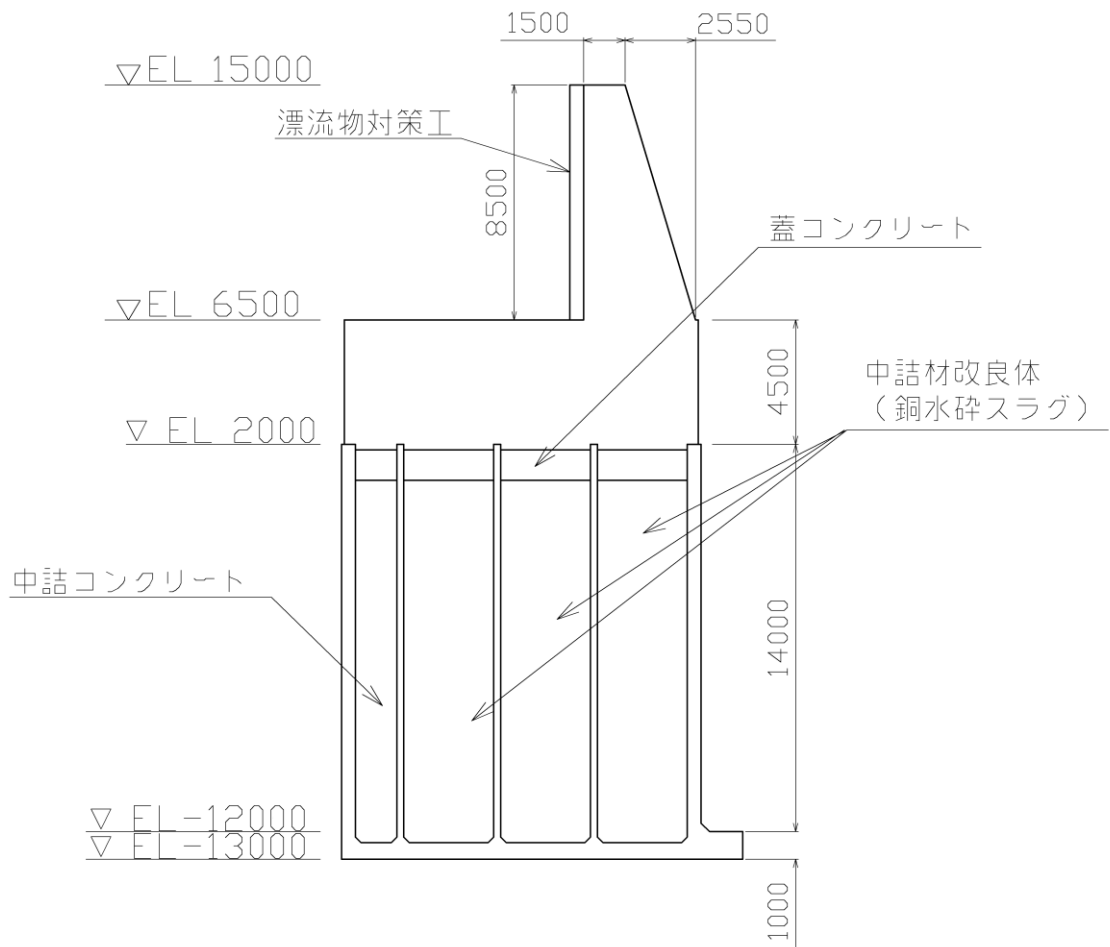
(3) 防波壁 (波返重力擁壁) の構造図 (断面図) (②-②断面)
